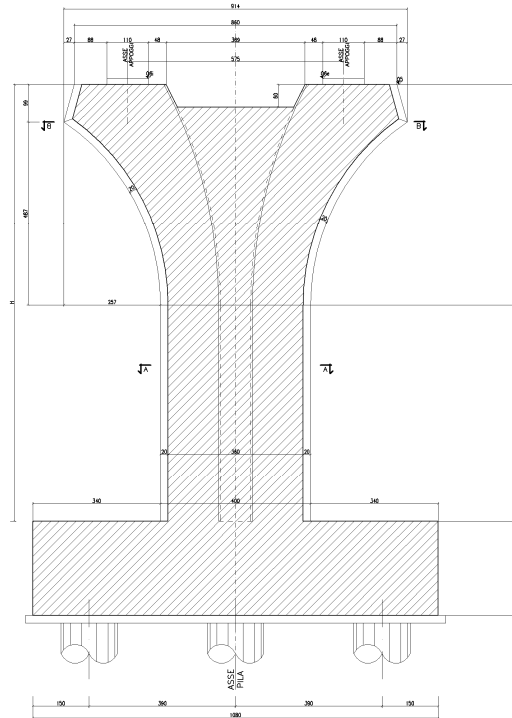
Sezione trasversale con fondazione tipo D.
